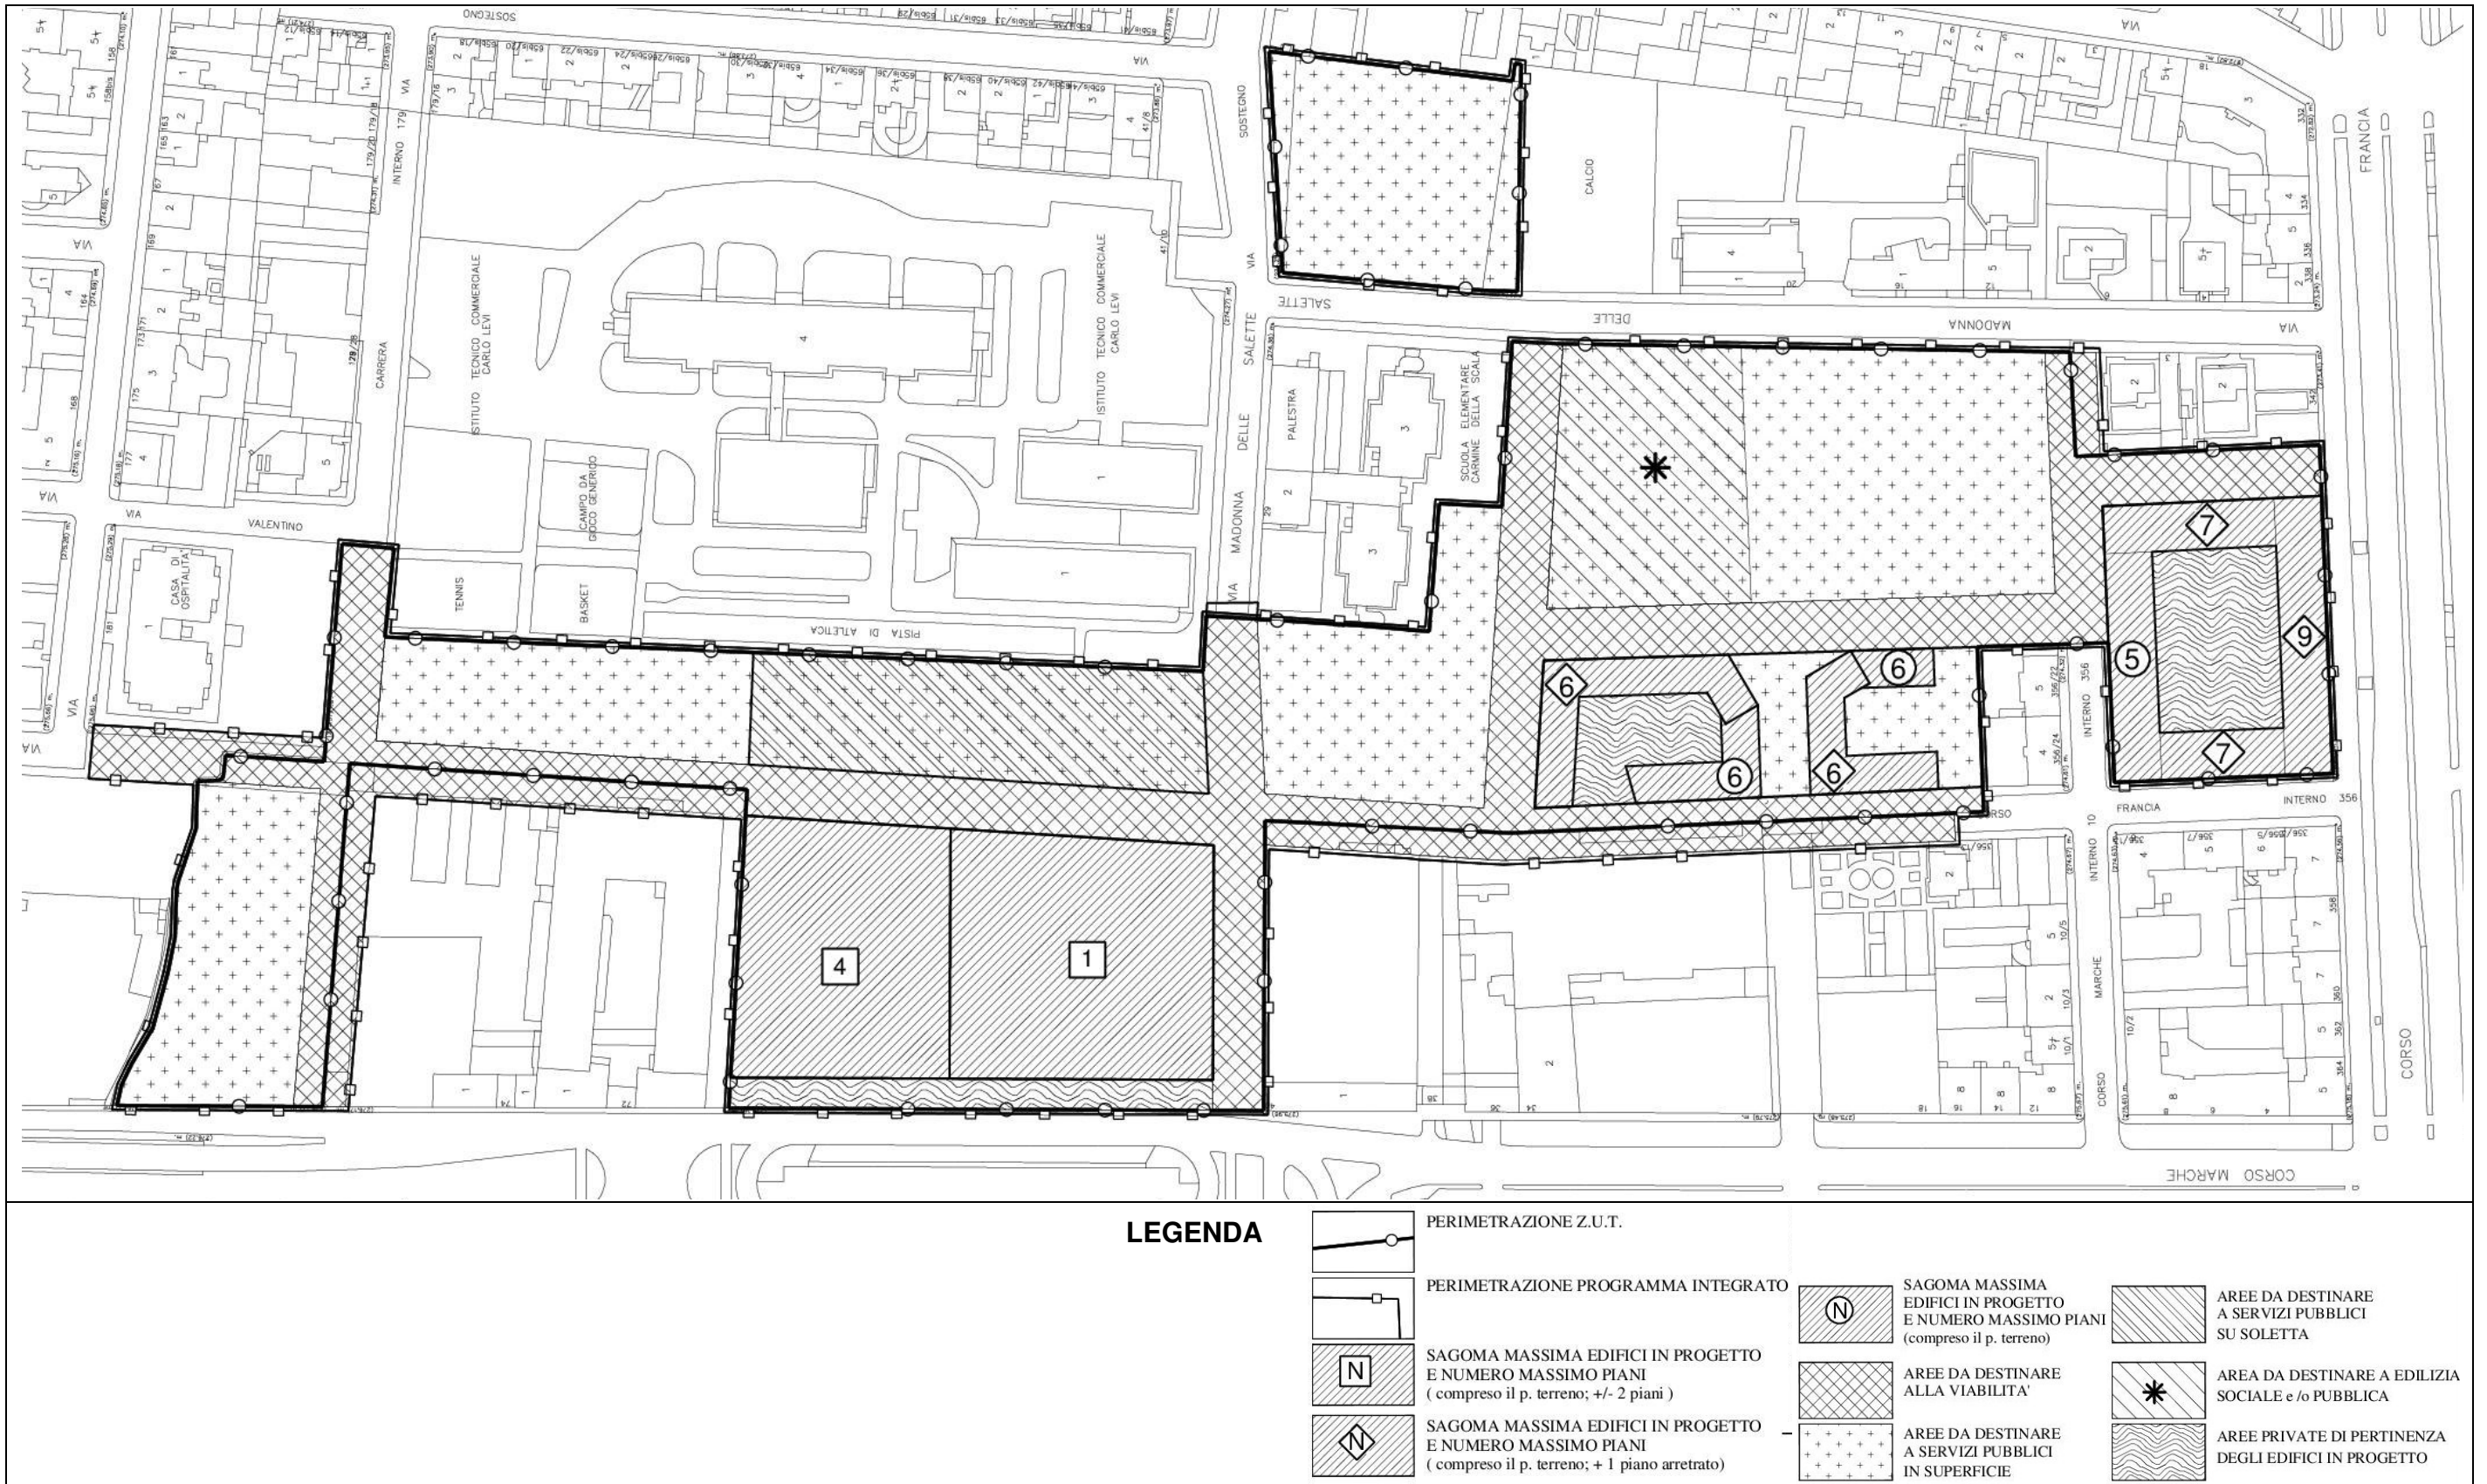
Planimetria di progetto della modifica al PRIN
